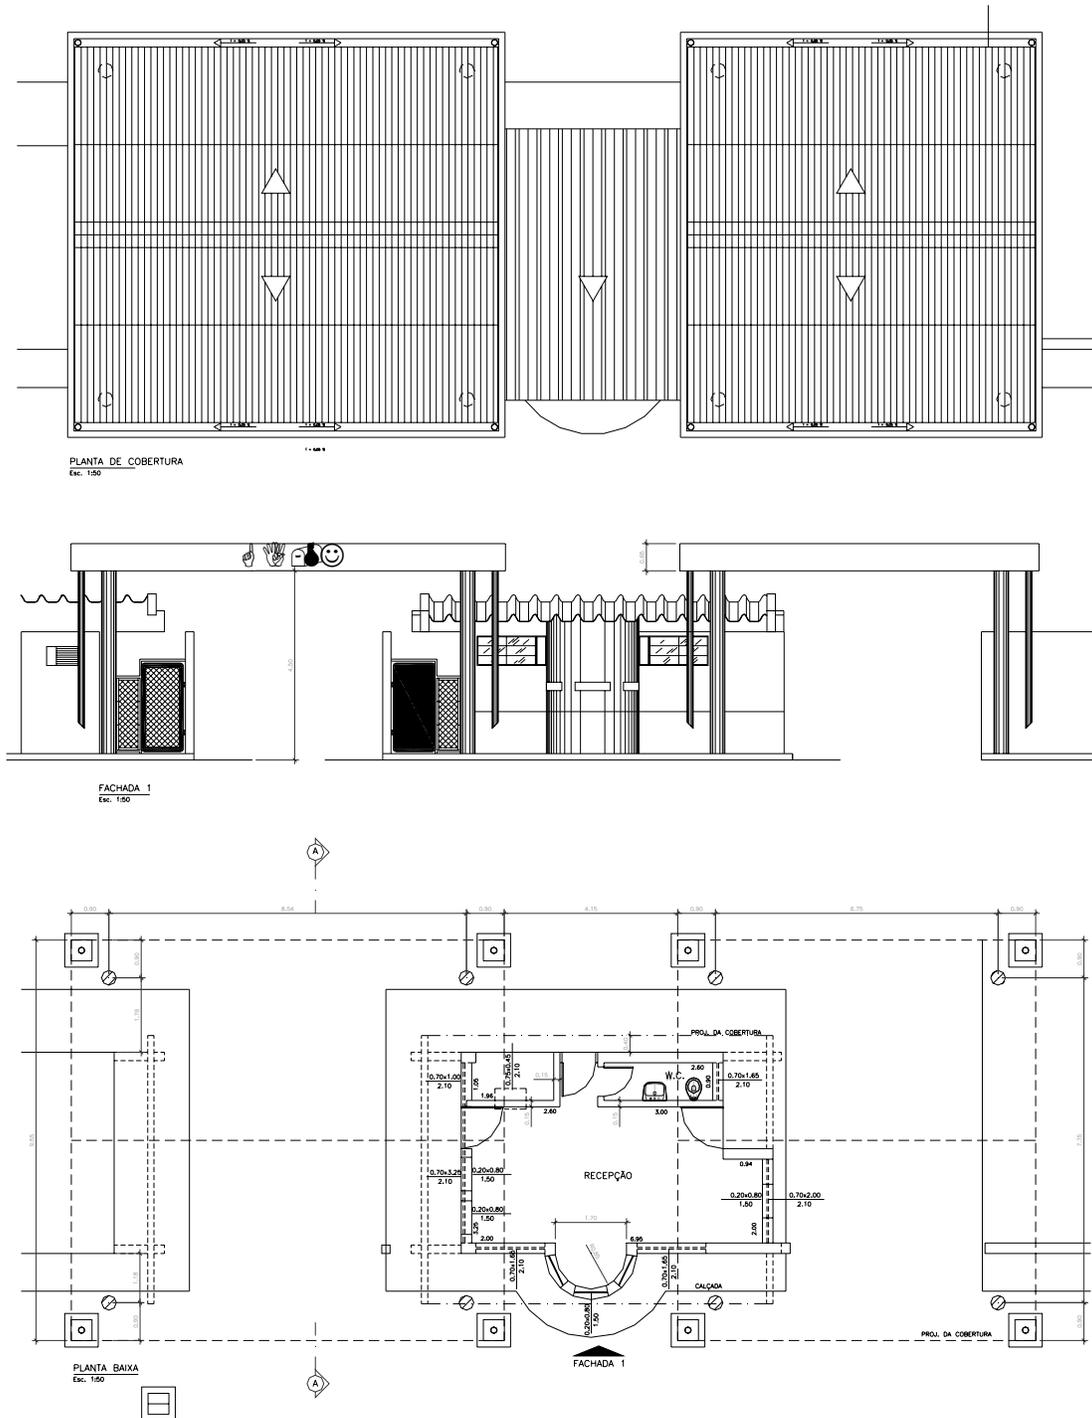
Planta de cobertura, Elevação frontal e planta baixa da cobertura para a portaria da Brejauveira.
